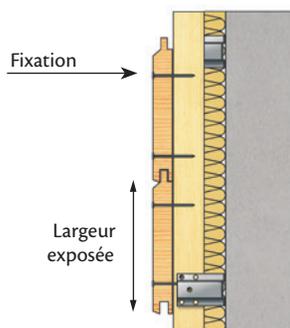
Fixations apparentes (lame $>$ 125 mm)
